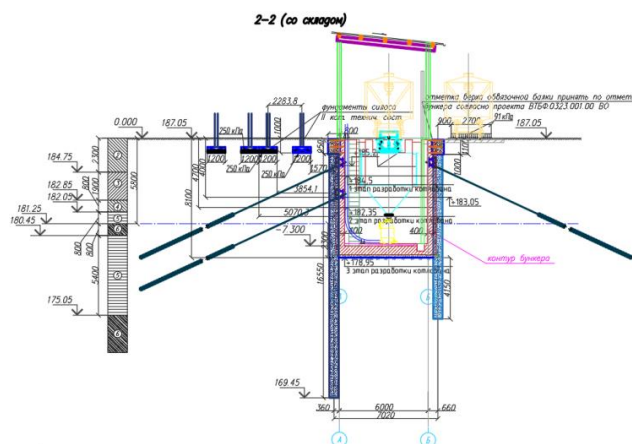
Схема вертикальной привязки заглубленных удерживающих конструкций строительного котлована.
